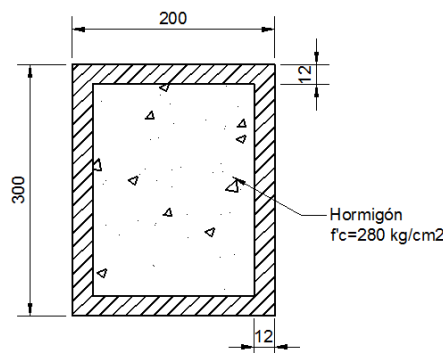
Sección transversal de la columna de acero rellena de hormigón.
